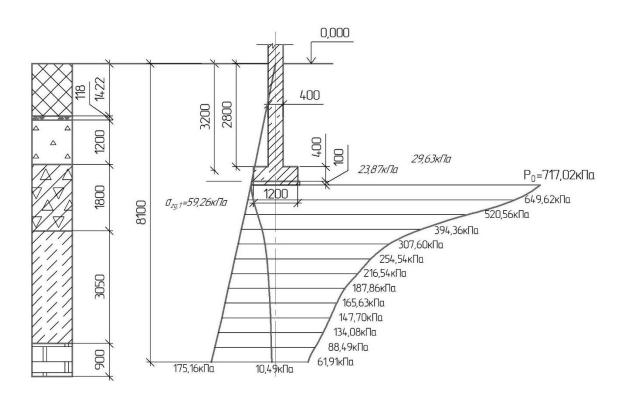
Схема расчета осадки ленточного фундамента
